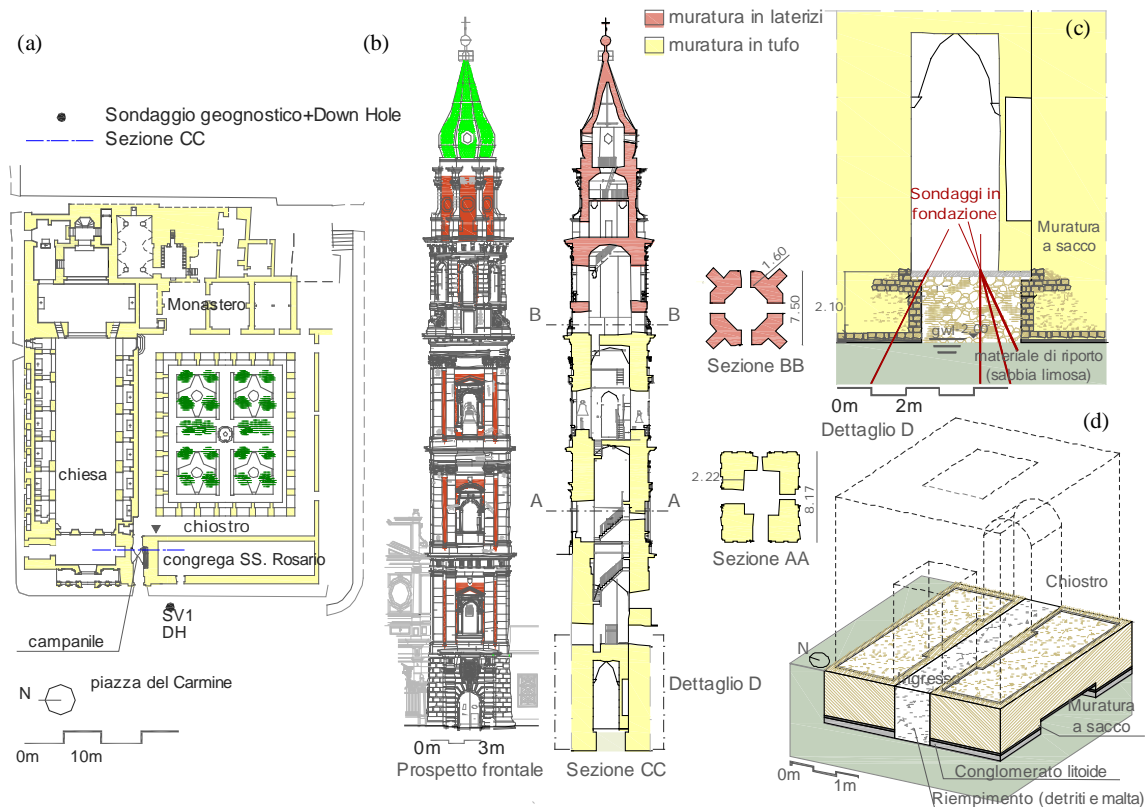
Pianta del complesso del Carmine (a), prospetto e sezione del campanile (b), particolare (c) e modello tridimensionale della fondazione (d).
